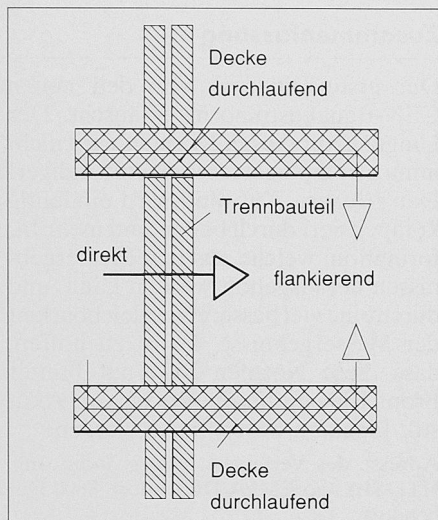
Zweischalige Trennbauweise mit durchlaufender Decke
